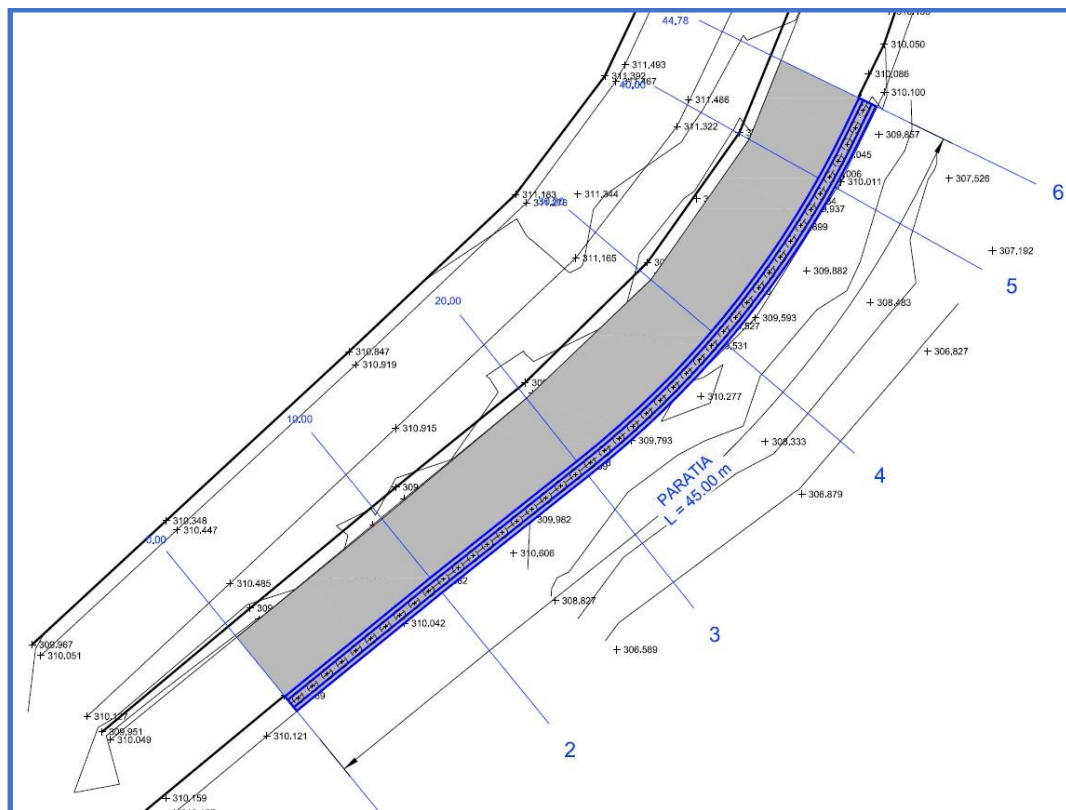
Zona intervento 1 – Planimetria dell'intervento
